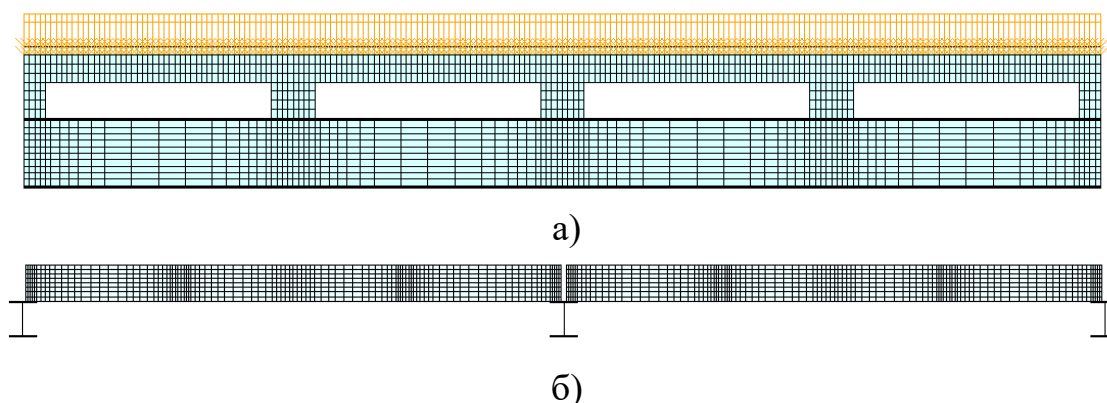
Схема прикладання навантаження до плит покриття (а) і загальний вид розрахункової схеми перекриття (б)
